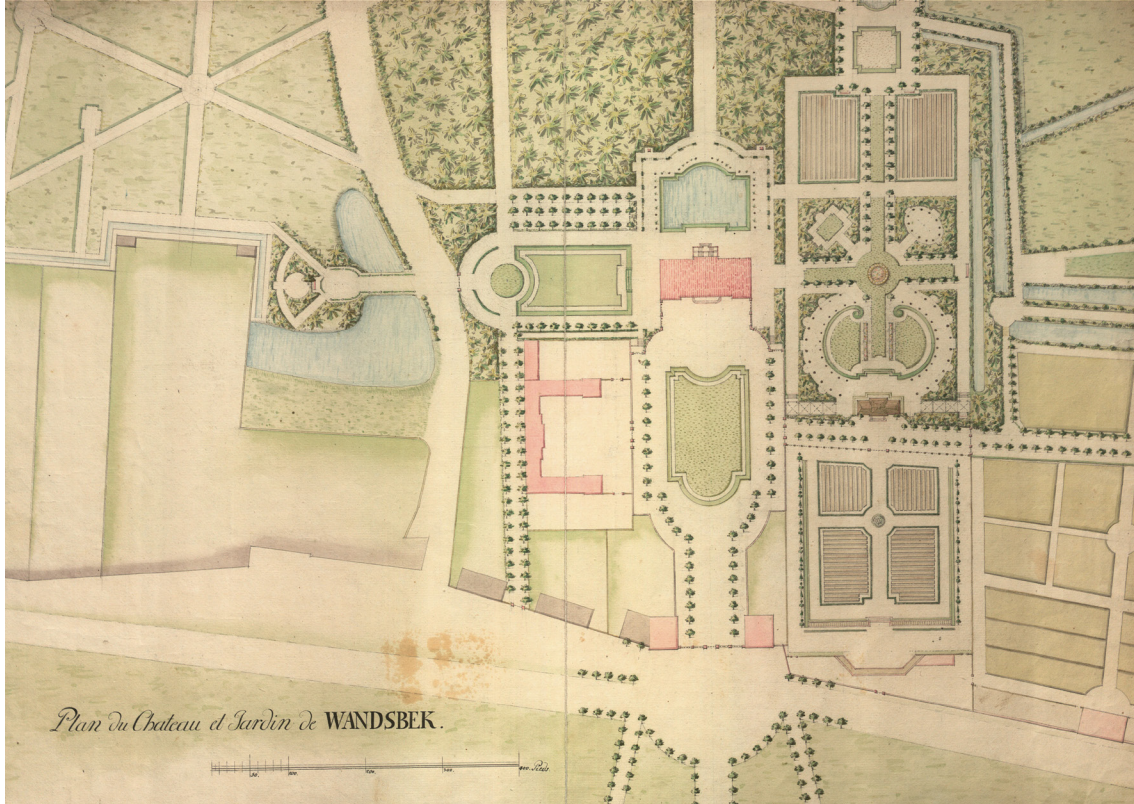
Carl Gottlob Horn, Entwurf für den Garten in Wandsbek, Version des Herrenhauses mit rechteckigem Grundriss, um 1766–1768, Staatsarchiv Hamburg
